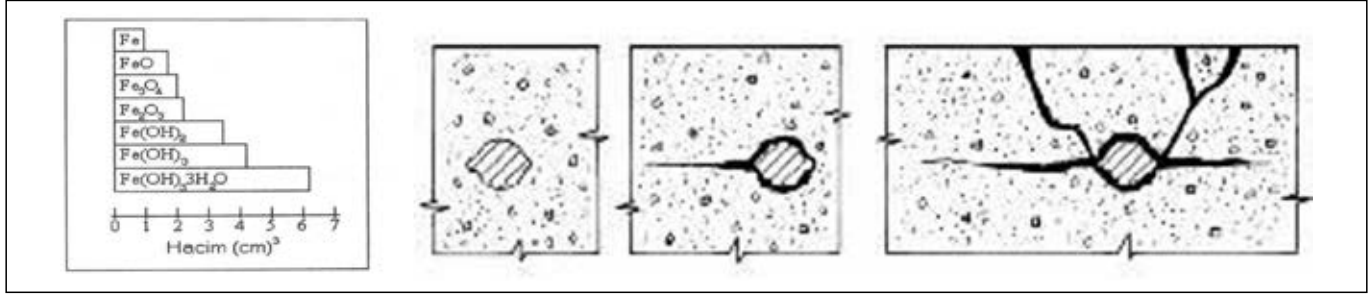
Donatıyı koruyan beton pas payı tabakası
